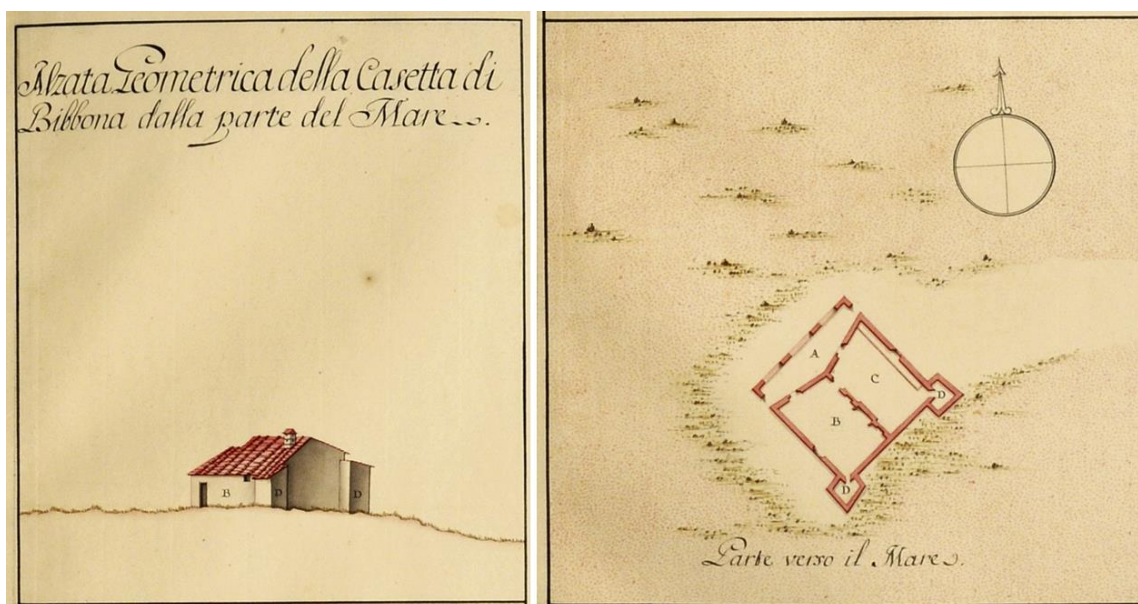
Dettaglio dell'alzata e della pianta della casetta di Bibbona, ASF, Segreteria di Gabinetto 696 pp.066-067
